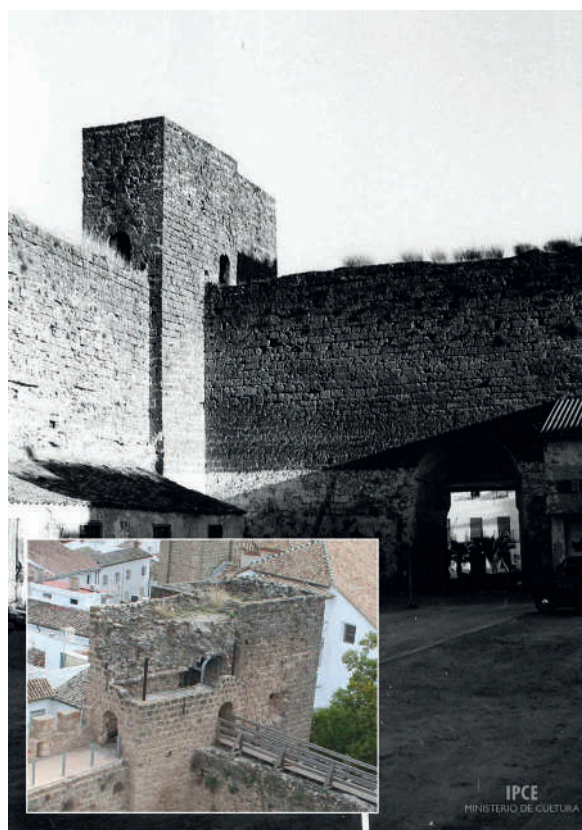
Imagen en torno a 1977 de la Torre 3, afectada por una grieta estructural, que fue desmochada y solo parcialmente reconstruida ese mismo año. En el recuadro, estado previo a las obras de 2019-2020 que han recuperado la volumetría original. Foto b/n: Archivo IPCE. Ministerio de Cultura.
